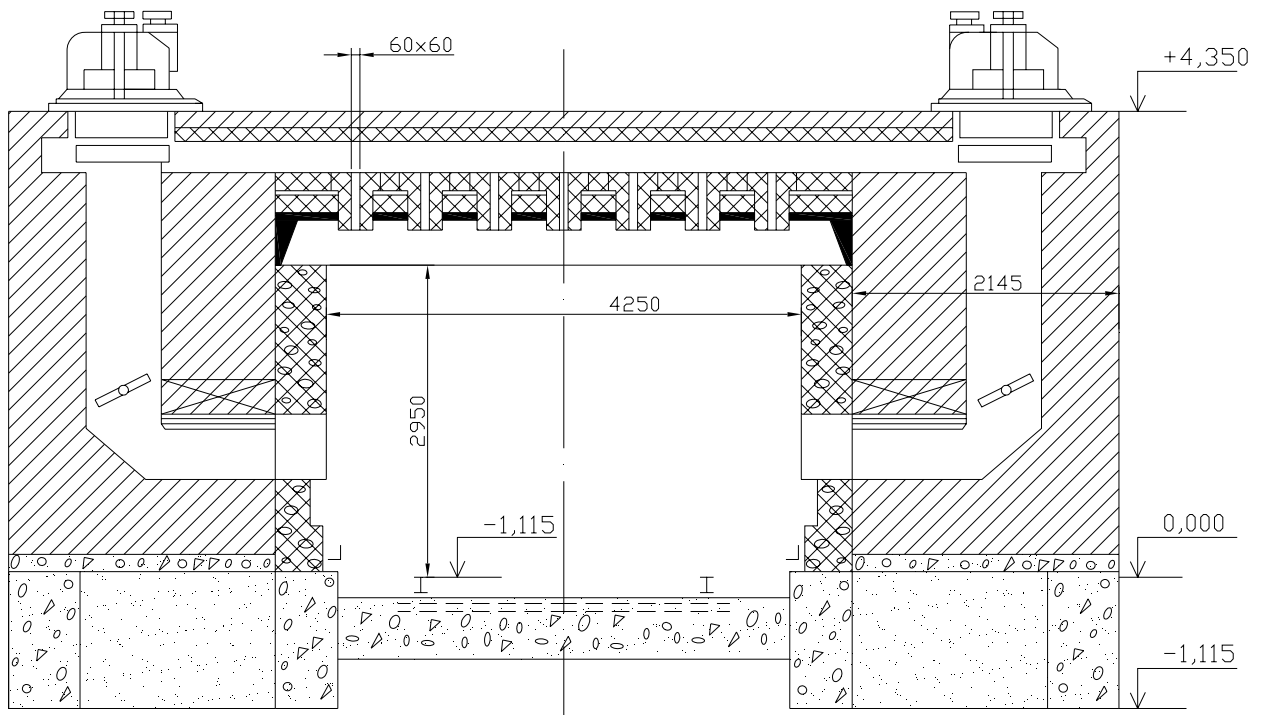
Разрез туннельной печи по зоне подогрева
